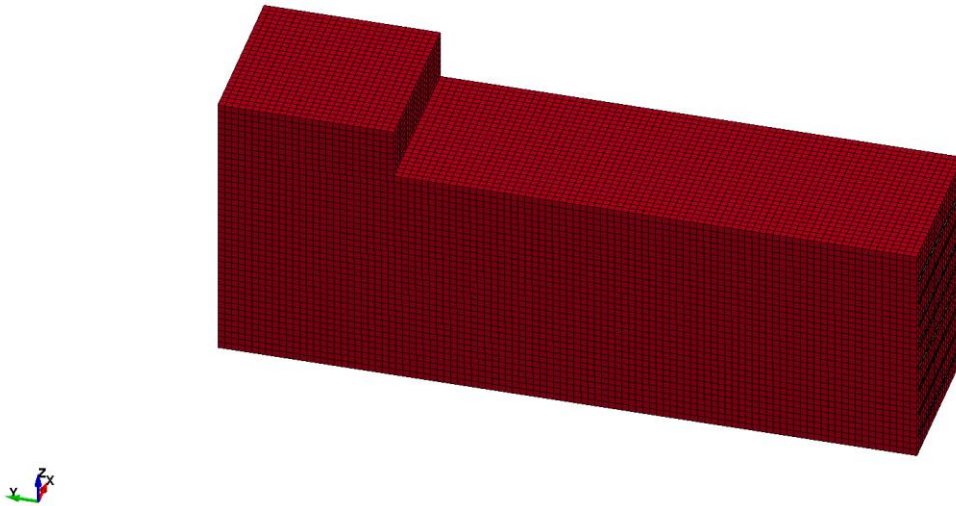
Vista de Hormigón en Modelo Estribo Simple de Puente Águila Norte.
